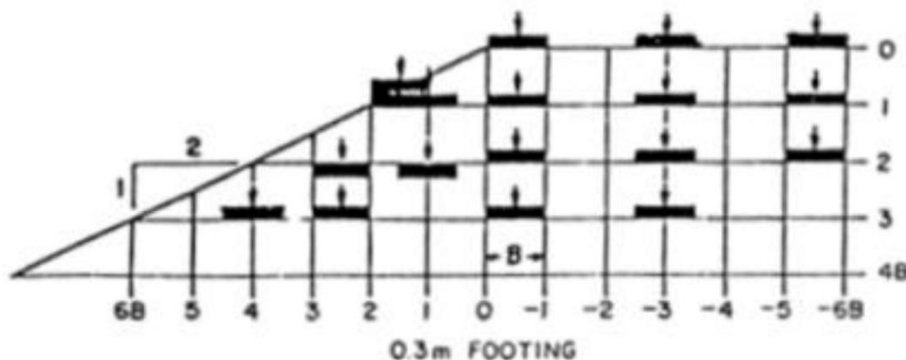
Emplacement des fondations (Bauer et al.1981)
